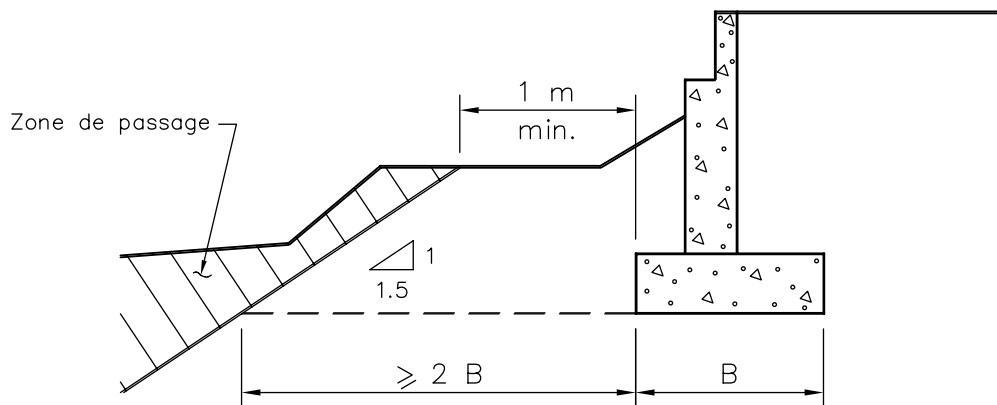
Zone de passage d'un conduit ou d'un groupe de conduits à l'avant d'une culée
